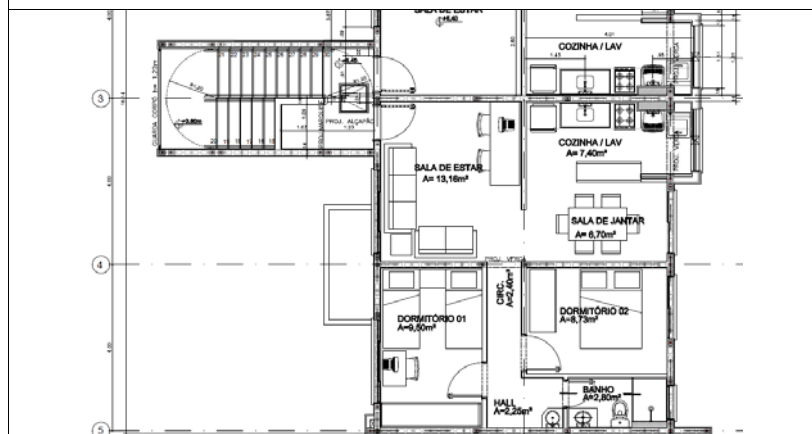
Planta 2º pavimento Edifício SB22. Fonte: CDHU (2012)
